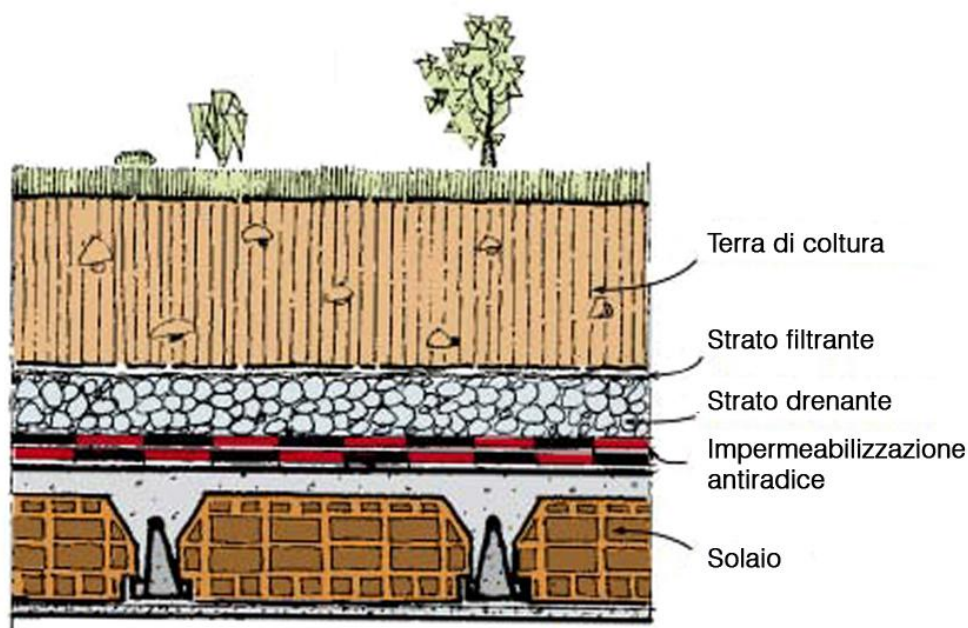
Illustrazione schematica dell'applicazione di un tetto verde di tipo intensivo
